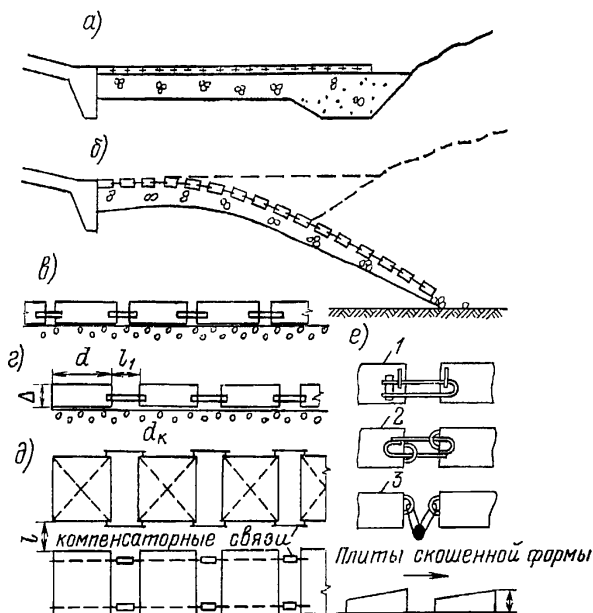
Конструкция переходного крепления из каменной наброски, покрытой бетонными плитами с компенсационными связями:
